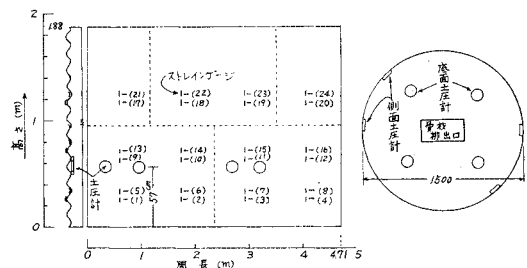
大波貯蔵ビン(溶接結合)展開図および平面図
